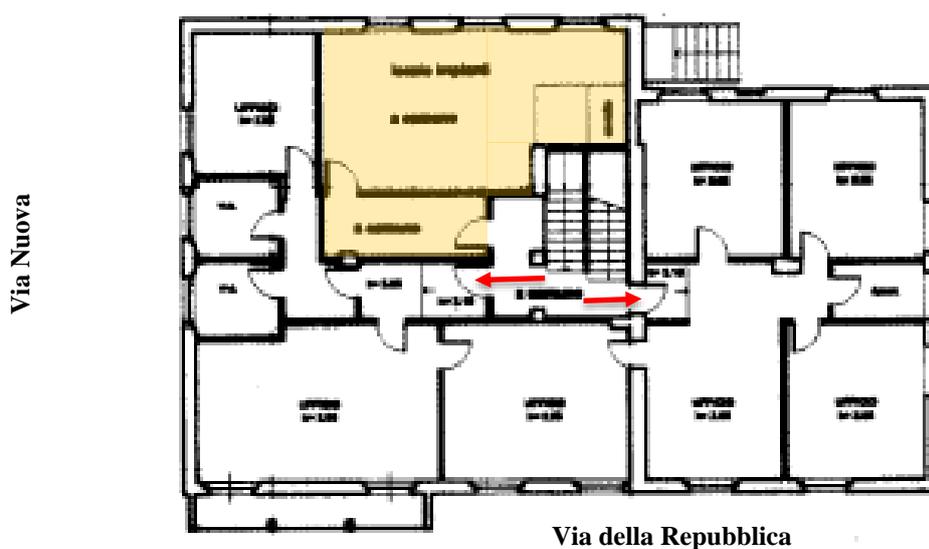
Stralcio della planimetria catastale dell'unità immobiliare oggetto di stima
